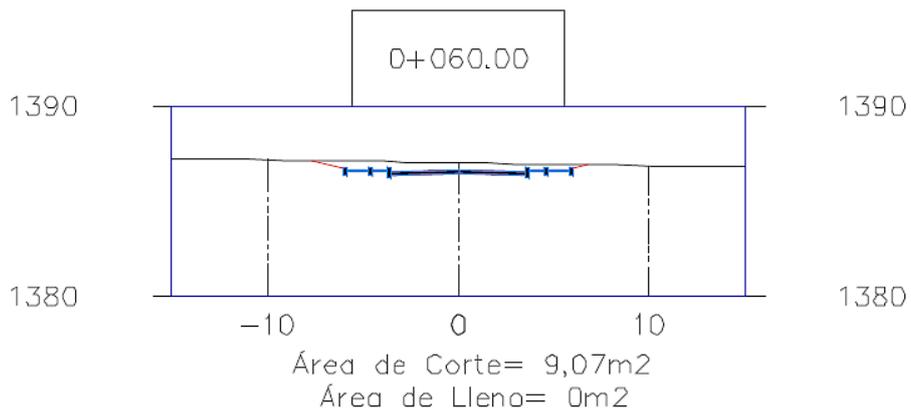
Sección Transversal, abscisa 0+060. Elaboración Propia
